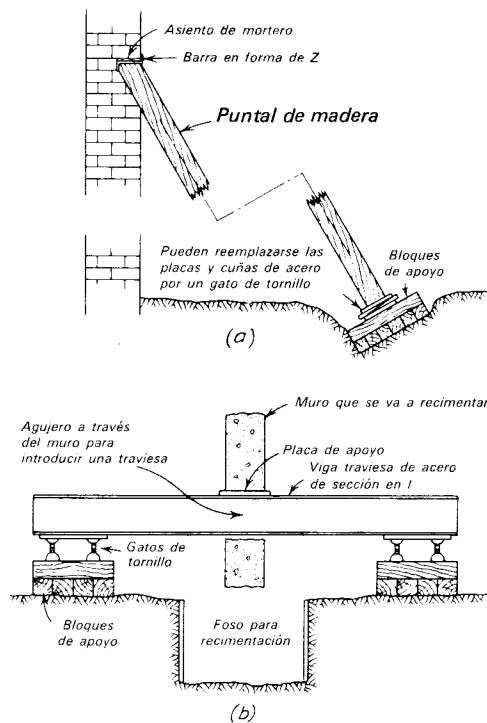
Métodos de apuntalamiento. a) Con ranuras en la pared. b) Viga atravesada.
